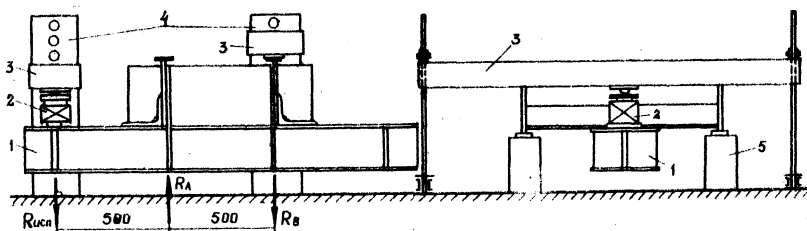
Конструкция стенда для испытания образцов узлов: 1-образец У-1; 2-гидродомкрат; 3-траверсы-упоры; 4-анкерные тяги; 5-опоры для установки образца.
